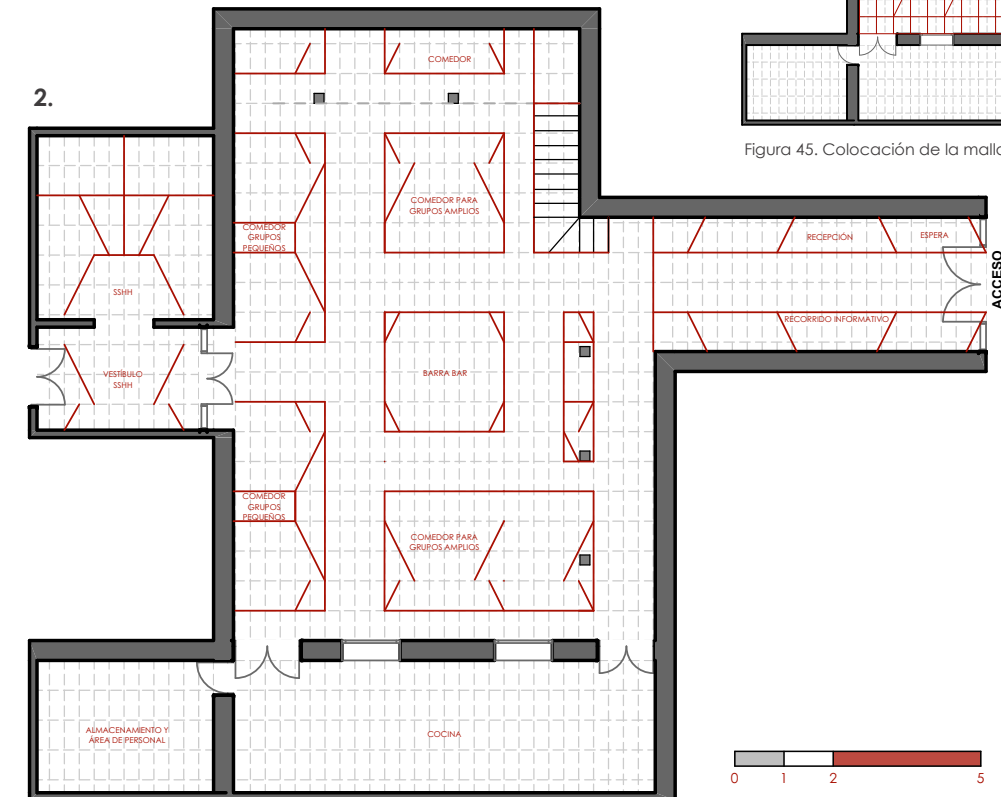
Aplicación de la malla en planta. Fuente: Elaboración Propia
